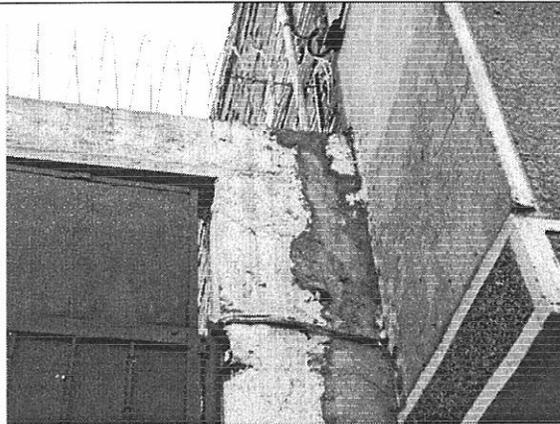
Fisuras en el apoyo del dintel en la cara interna.
